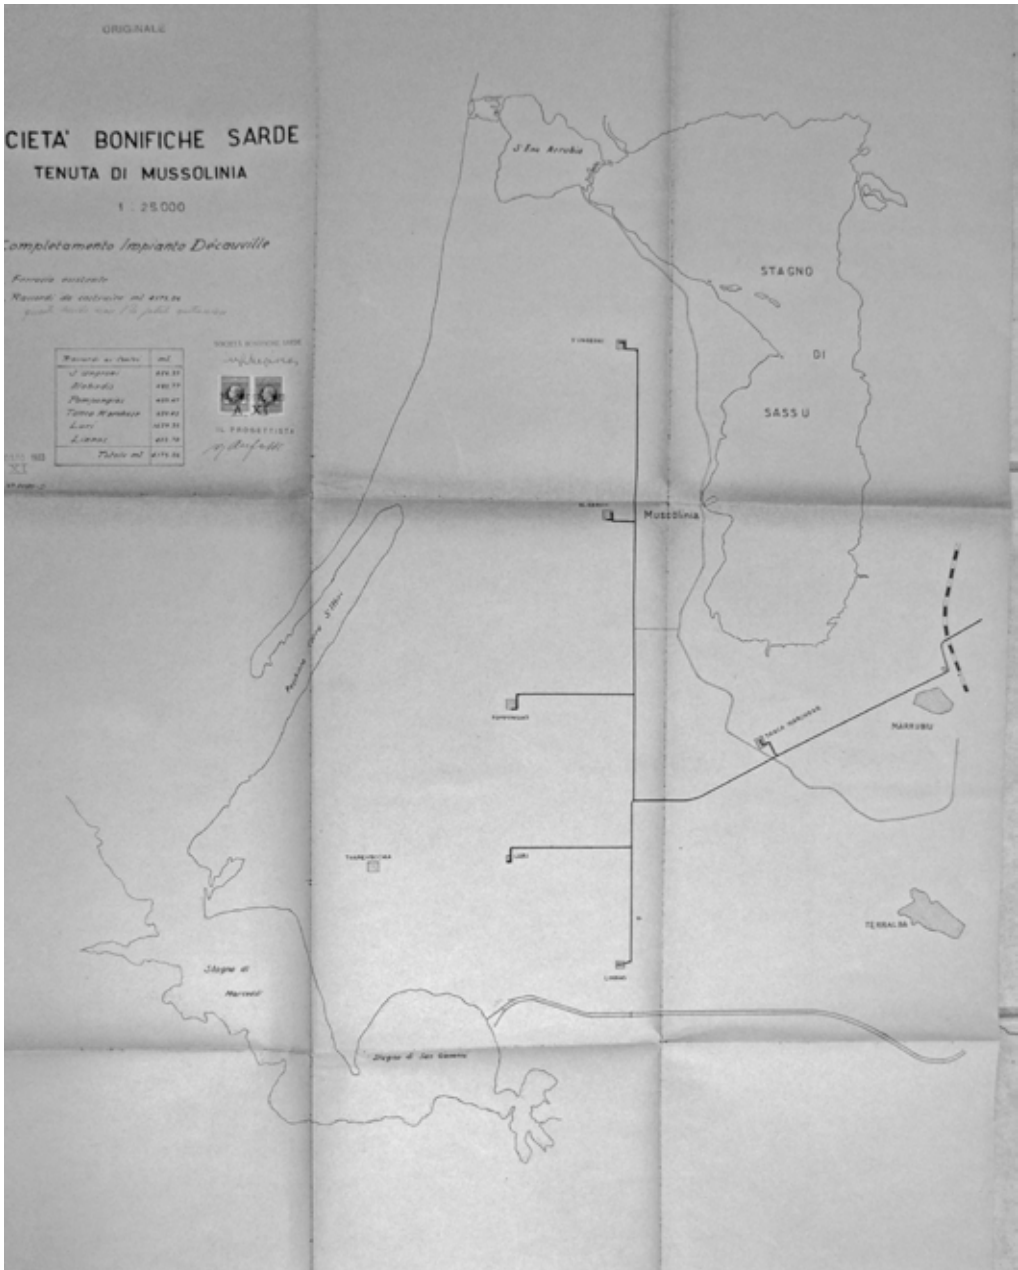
Completamento impianto Decauville - Planimetria scala 1:25.000.
